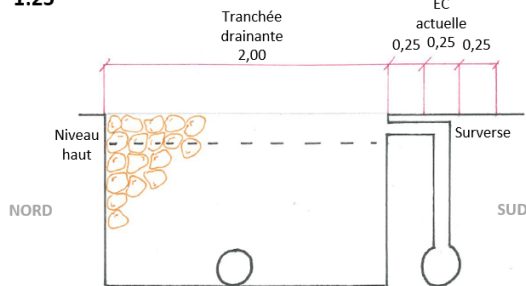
Profil de la tranchée drainante qui évacue les eaux du parking de la zone NORD.
